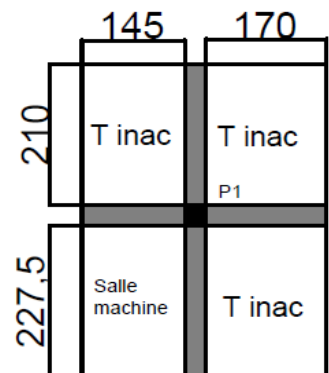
Surface afférente de poteau P1 au niveau terrasse inaccessible
